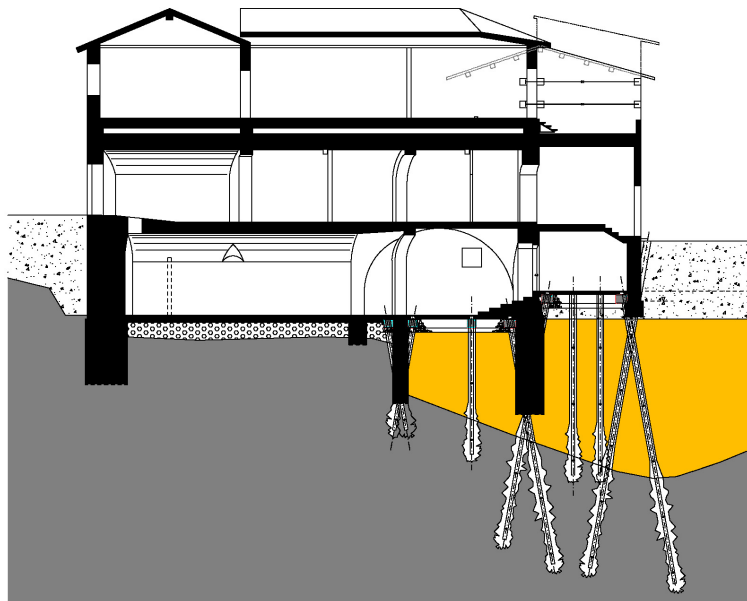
Sezione di progetto dell'intervento di consolidamento delle fondazioni di un antico edificio, di origine trecentesca, e dei successivi ampliamenti.
